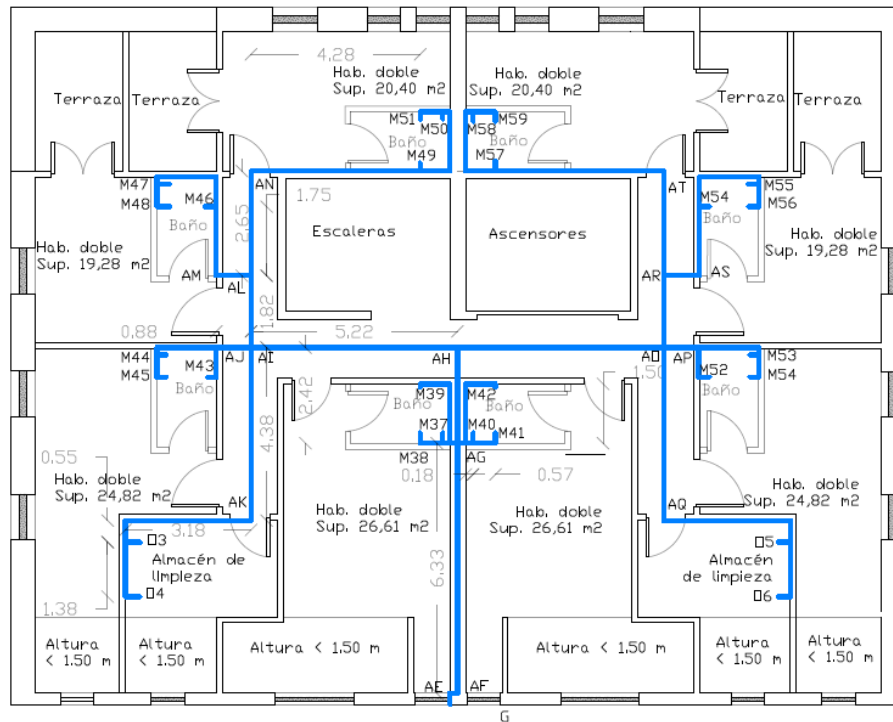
Plano de la red de suministro de agua de la segunda planta. Fuente: Elaboración propia
